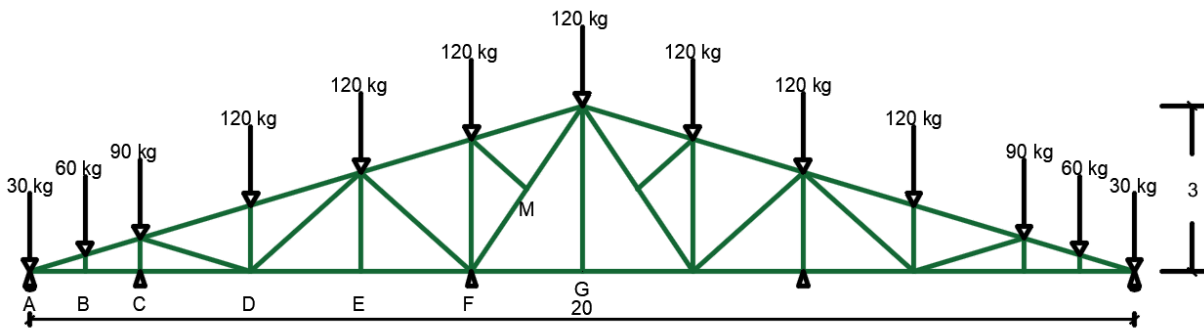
Cargas puntuales debido a la carga de nieve en las armaduras externas - Norma Peruana. Fuente: Elaboración Propia
